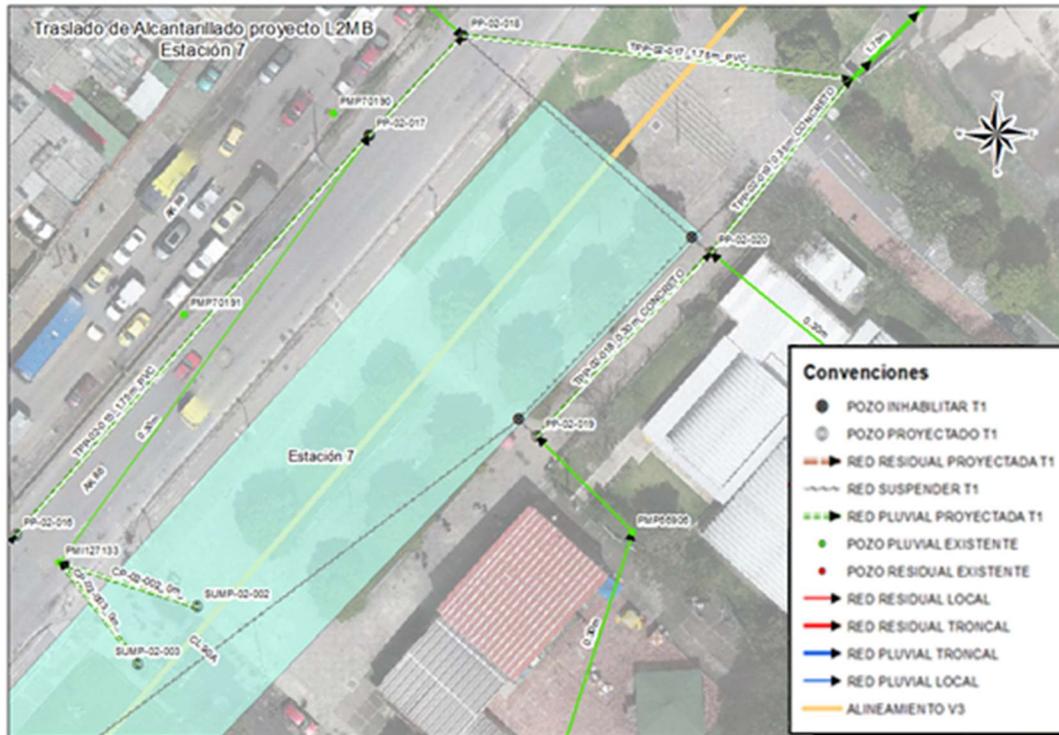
Traslado redes de alcantarillado Estación 7 Carrera 86 con calle 90A Red Pluvial
